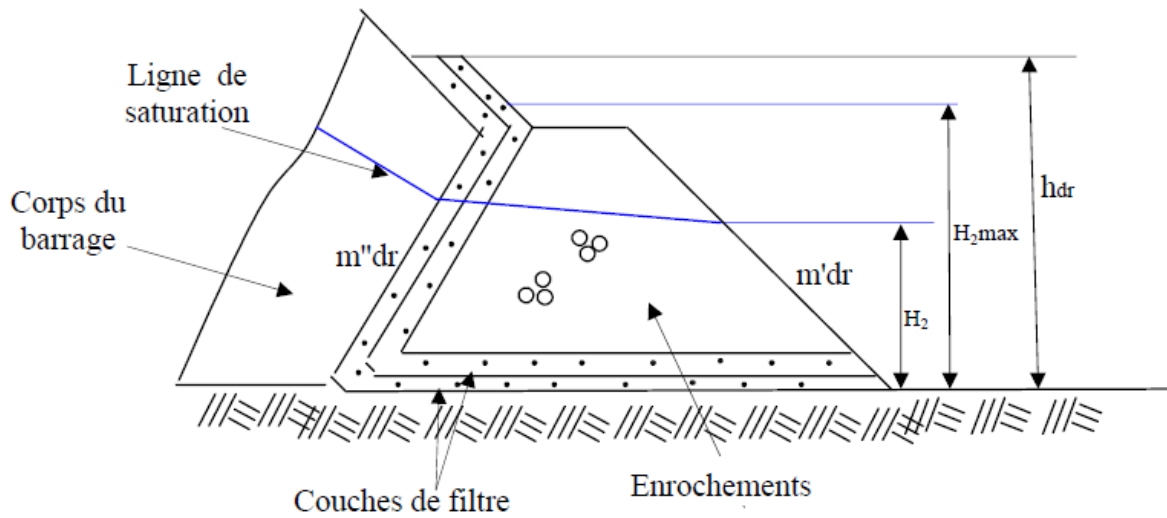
Prisme de drainage avec drainage de surface (Messaid, 2002).
